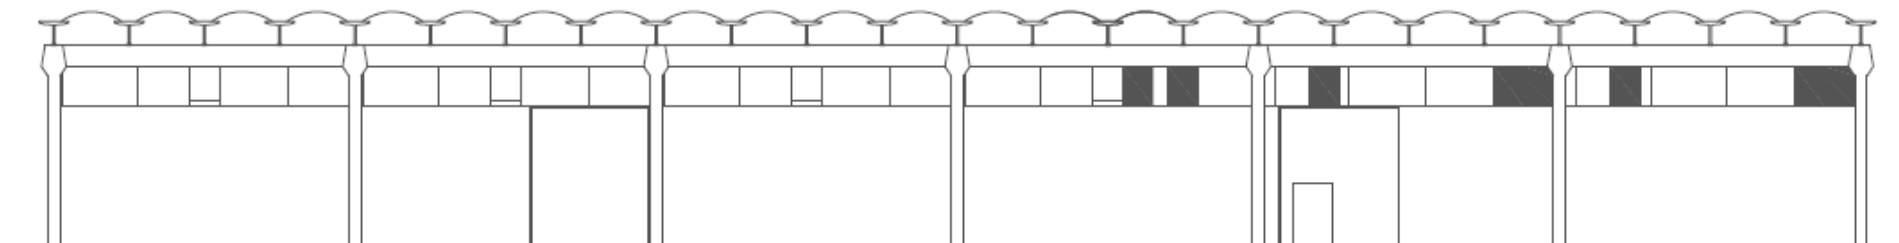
Prospetto del fianco destro (rispetto la vista dell'ingresso principale) dello stabilimento.
